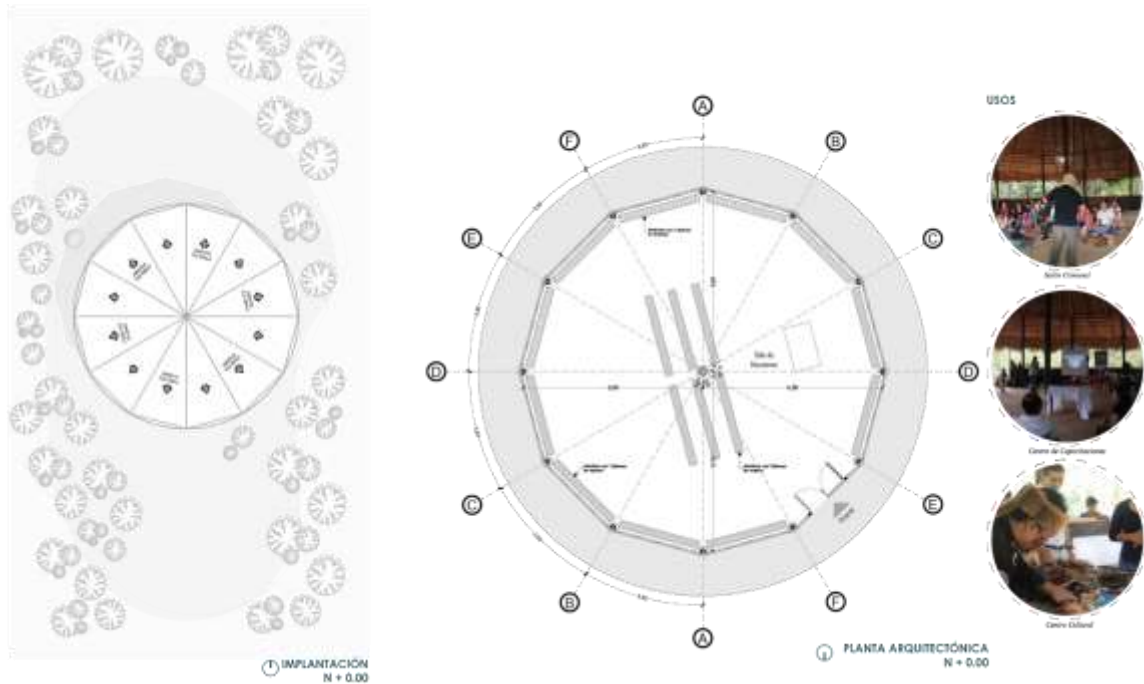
Levantamiento Arquitectónico CHINIM JEA
